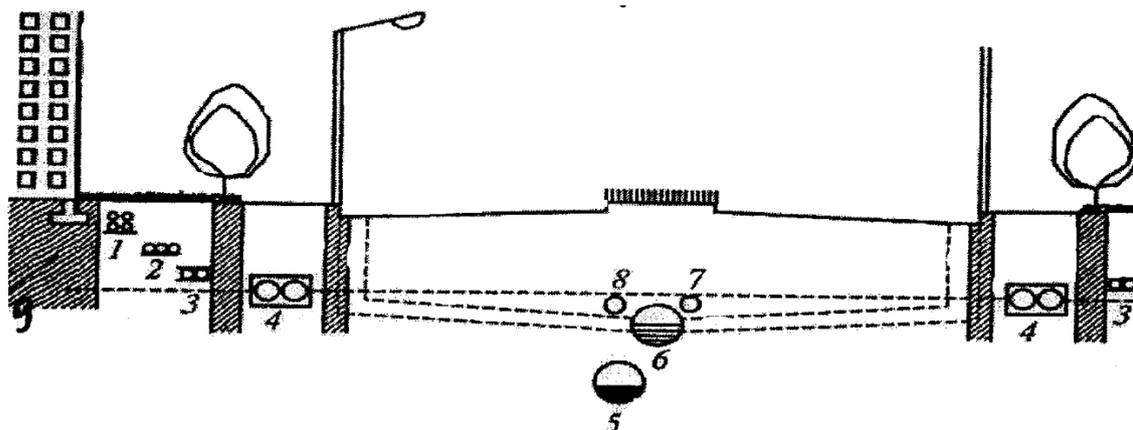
Схема раздельной прокладки инженерных сетей в поперечном профиле улицы: 1 – слаботочные кабели; 2 – силовые кабели; 3 – телефонные кабели; 4 – теплосеть; 5 – канализация; 6 – водосток; 7 – газопровод; 8 – водопровод; 9 – граница зоны промерзания.
